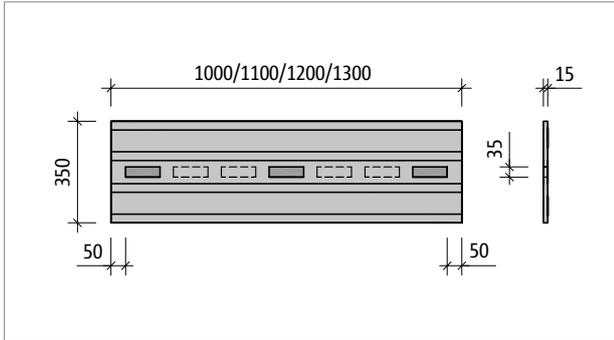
Schöck Tronsole® Typ B-V1...-B350: Produktgrundriss
